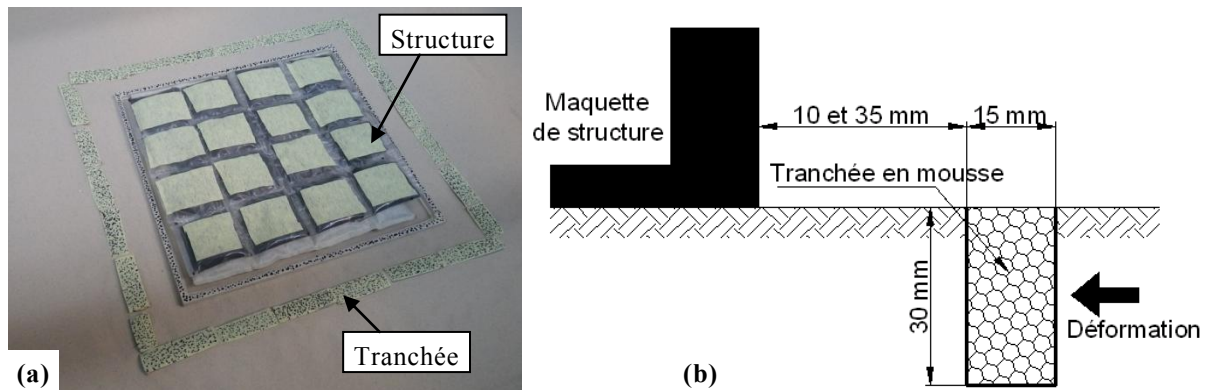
(a) Maquette de tranchée placée à 35 mm autour de la maquette de structure ; (b) caractéristiques géométriques de la maquette de tranchée
